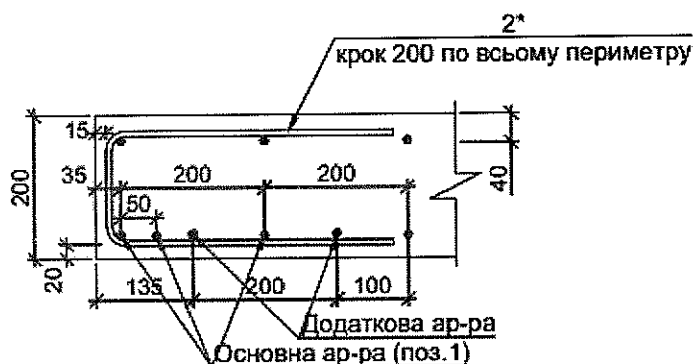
Фрагмент конструкції залізобетонної плити перекриття типового поверху будівлі ПМ-1.
